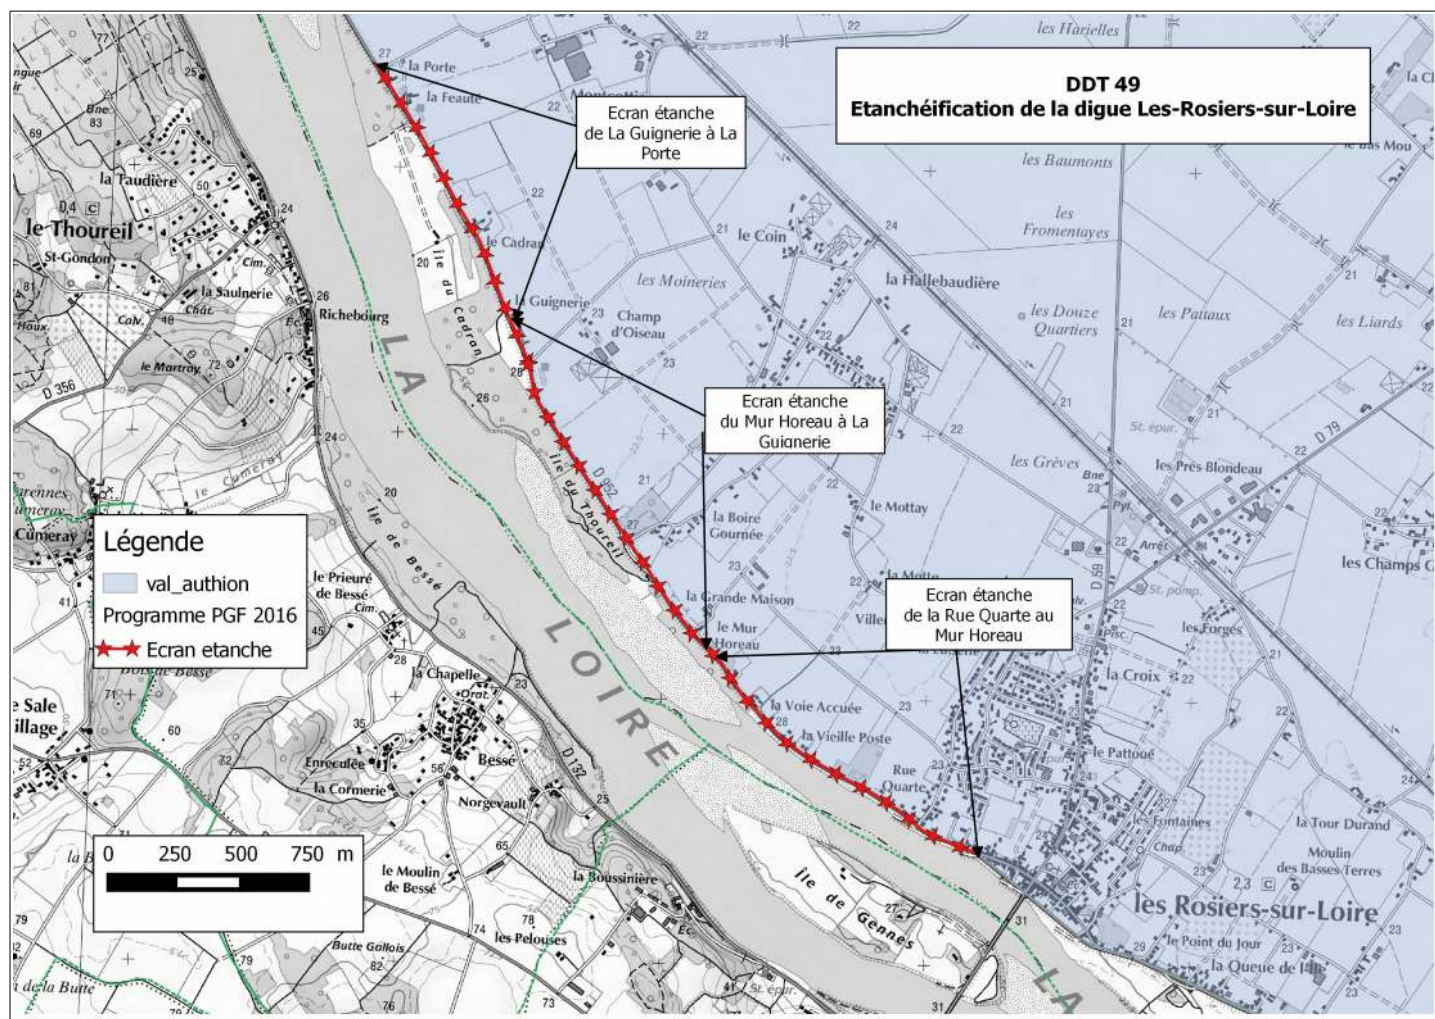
Plan de situation : Étanchéification de la digue aux Rosiers-sur-Loire
